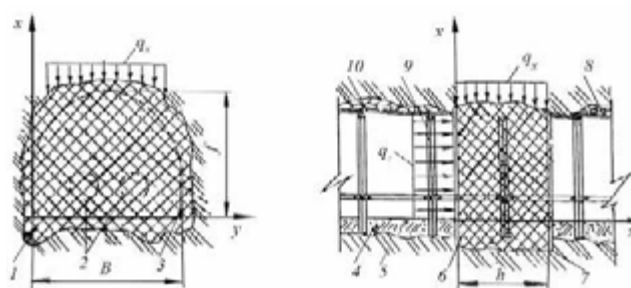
Расчетная схема взрывоустойчивой перемычки: 1 – наливная гипсовая перемычка; 2 – проемная труба; 3 – контур крепи в свету; 4 – подсыпка почвы выработки; 5 – монолитная порода; 6 – опалубка; 7 – контур вруба в зоне перемычки; 8 – закладка породой; 9 – металлическая арочная крепь; 10 – затяжка
